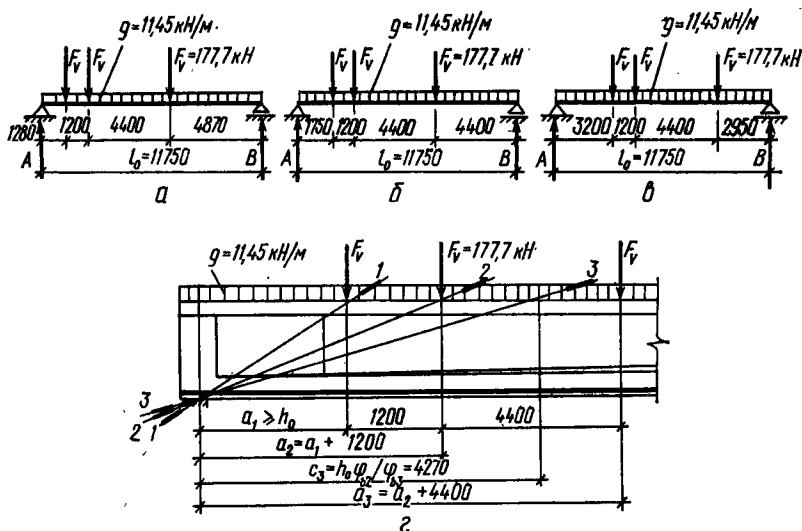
К расчету подкрановой балки на действие поперечных сил: а, б, в — схемы загрузки; г — положение расчетных сечений
